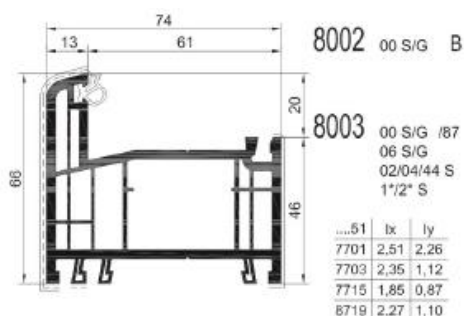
Planșa în secțiune transversală a ramei (Cat. No. 8003.00) profile PVC.
